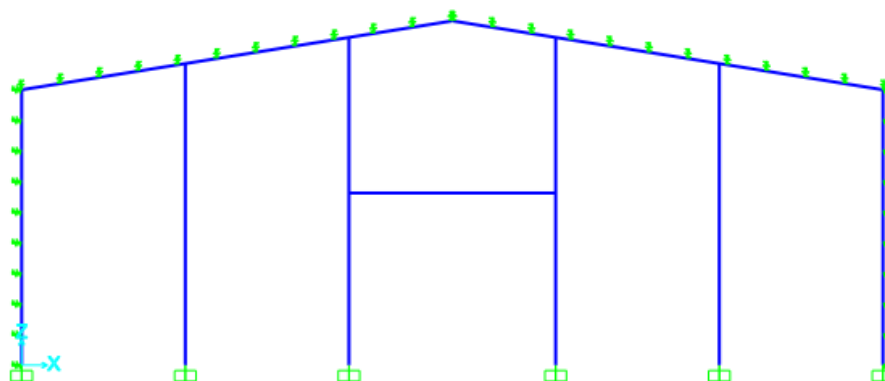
Pórtico hastial con pilarillos y cerramiento practicable.
